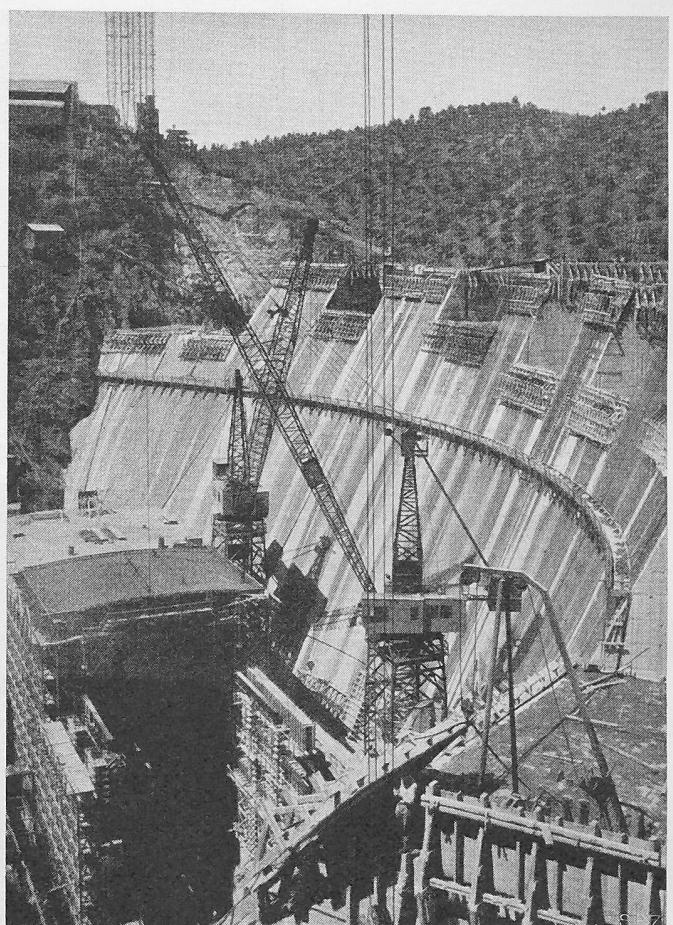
Betonierung Staumauer und Maschinenhaus. 3. Aug. 1949. 40 m, 7 t bei 35 m. 30. Sept. 1948
